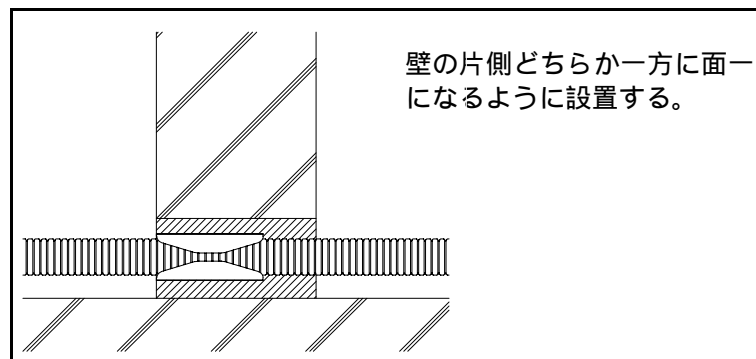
防火区画貫通継手T (トーセツ製) 施工図
